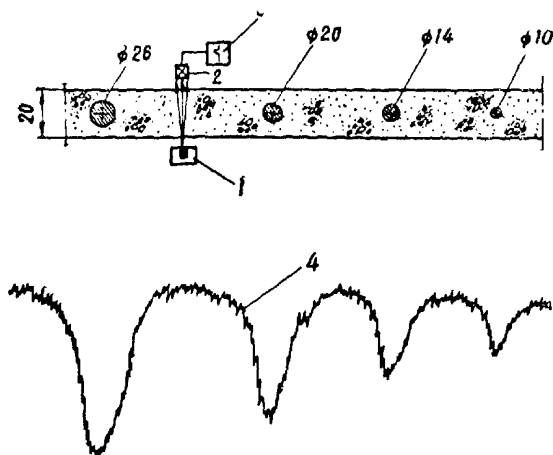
Схема радиометрического контроля параметров армирования (железобетонная плита толщиной 20 см с арматурными стержнями разных диаметров):
